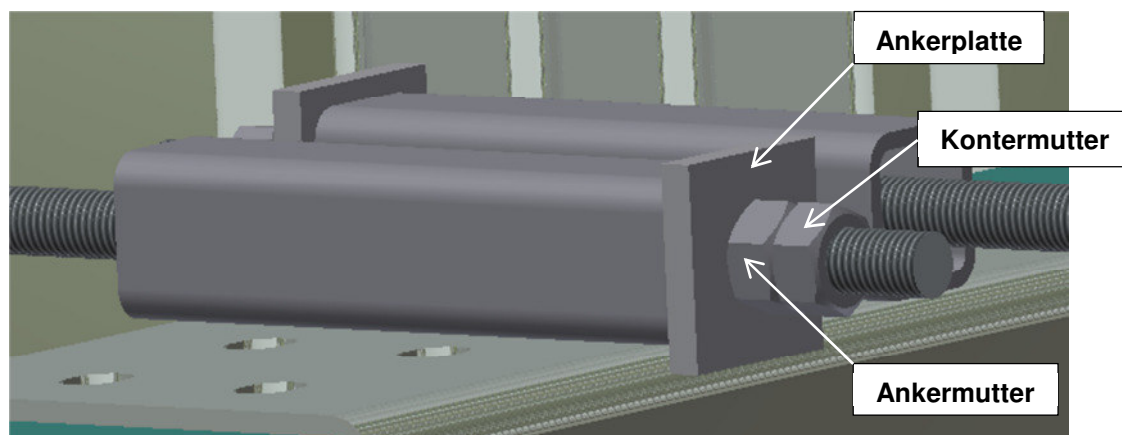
Detail Verschraubung mit Ankerplatte und Kontermutter
